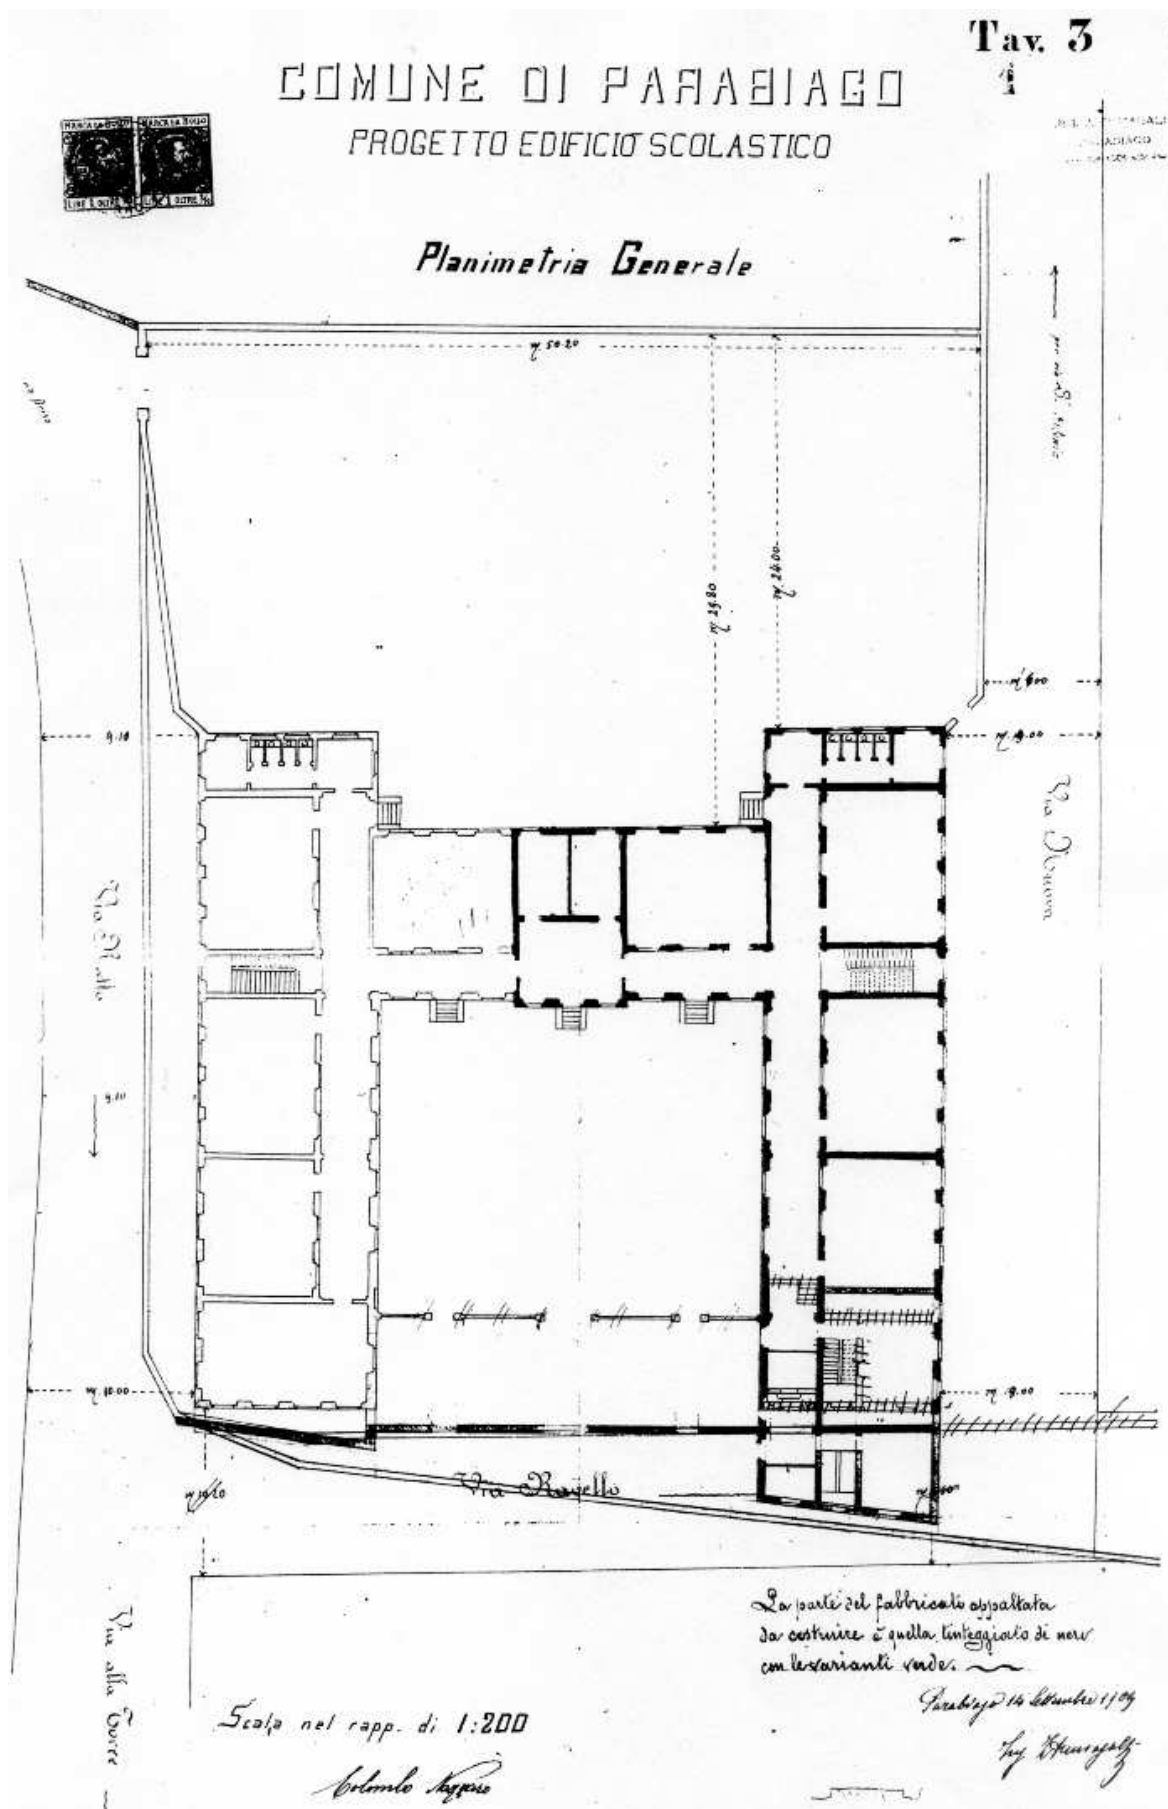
Planimetria generale del progetto dell'Ing. Fumagalli.
